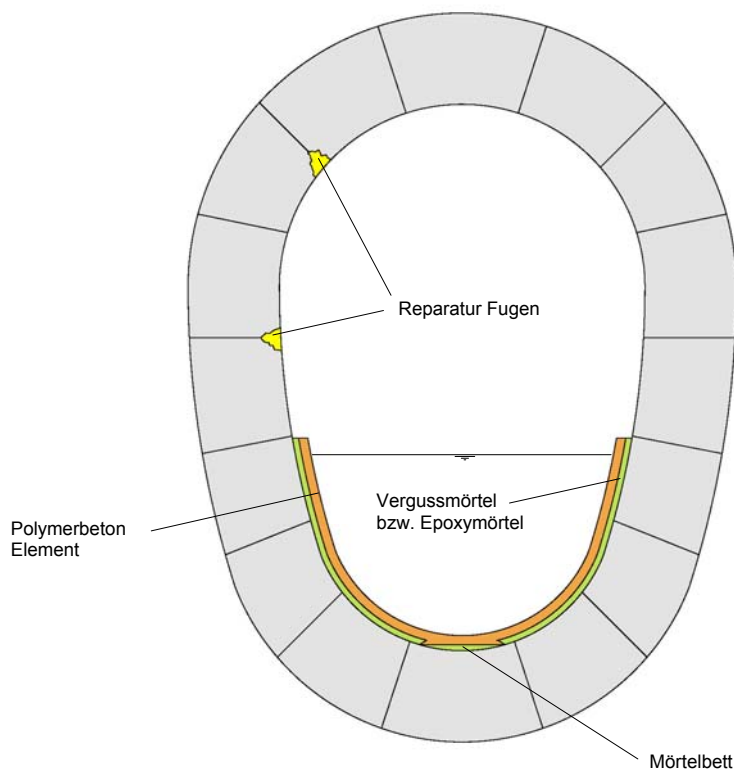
Sanierung Querschnitt mit Polymerbeton-Elementen
